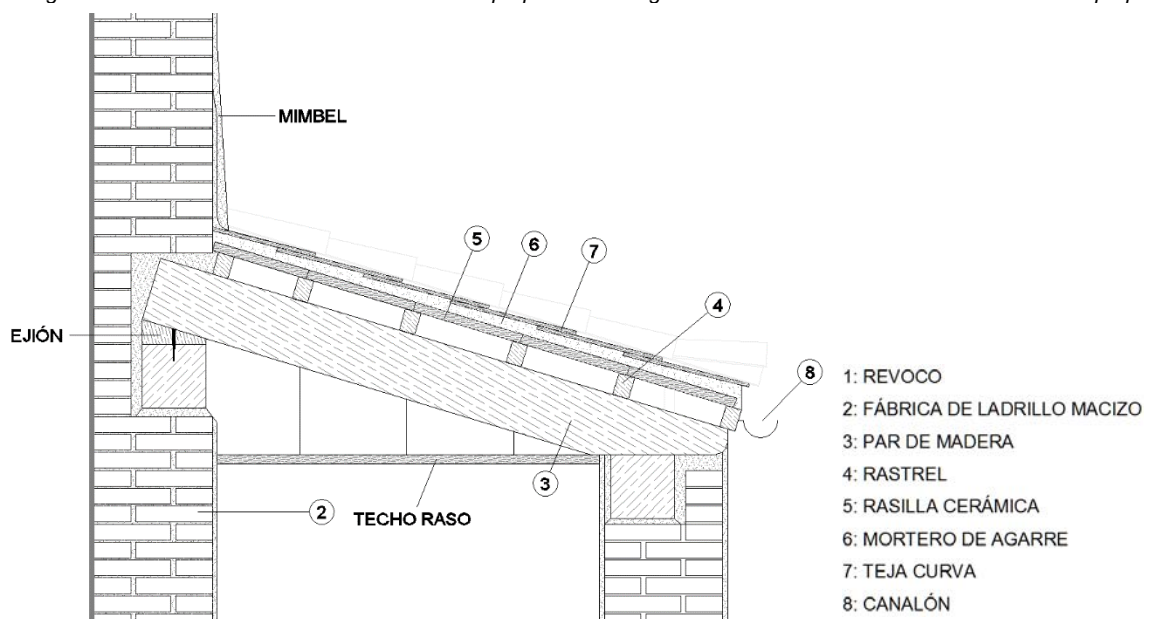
Detalle de cubierta de fachada posterior del edificio. Fuente propia.
